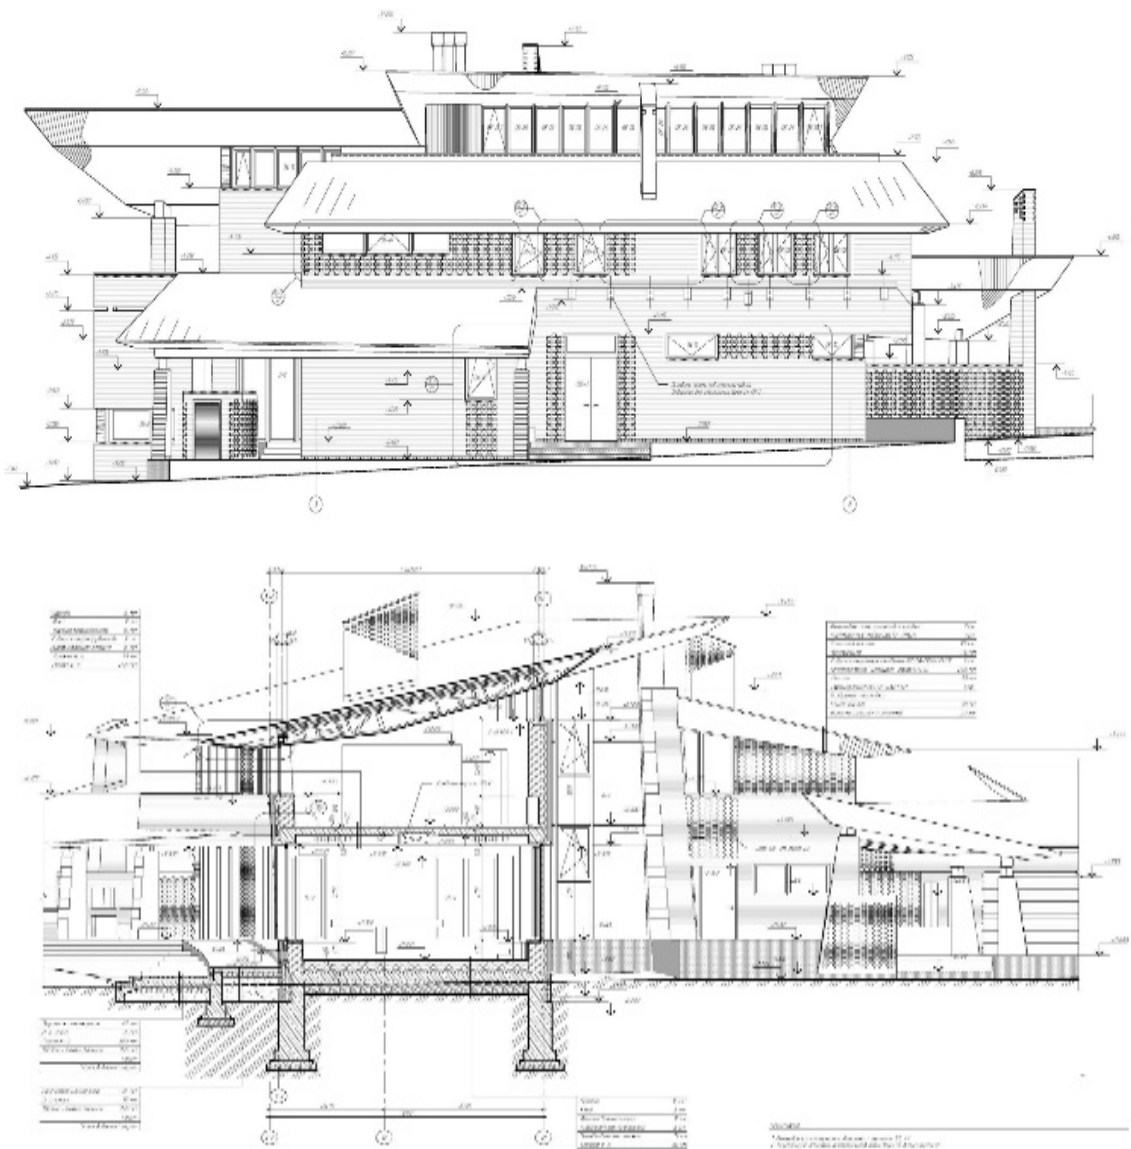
Примеры чертежей: а) фасад; б) разрез [5]
